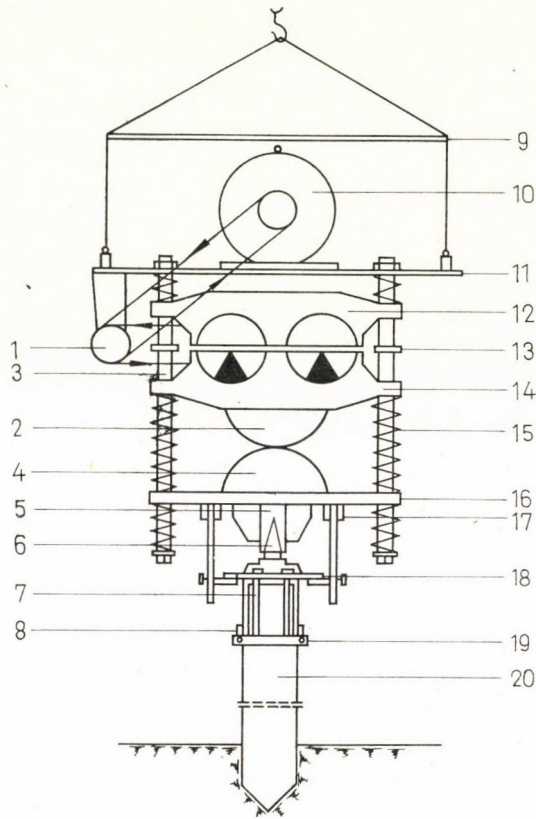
Prinzipschema des verwendeten Schlagrüttlers. 1 — Zwischenachse; 2 — Hammer; 3 — Führungsstab; 4 — Amboß; 5 — Haube; 6 — kegelförmiger Bolzen; 7 — Schraube; 8 — Plättchen; 9 — Rahmen; 10 — Motor; 11 — Stützplatte; 12 — Rüttler; 13 — Schraubennutter; 14 — Führungsring; 15 — Feder; 16 — Grundplatte; 17 — Befestigungseinrichtung mit Achse; 18 — Platte des Kegels; 19 — Schraube; 20 — Pfahl
